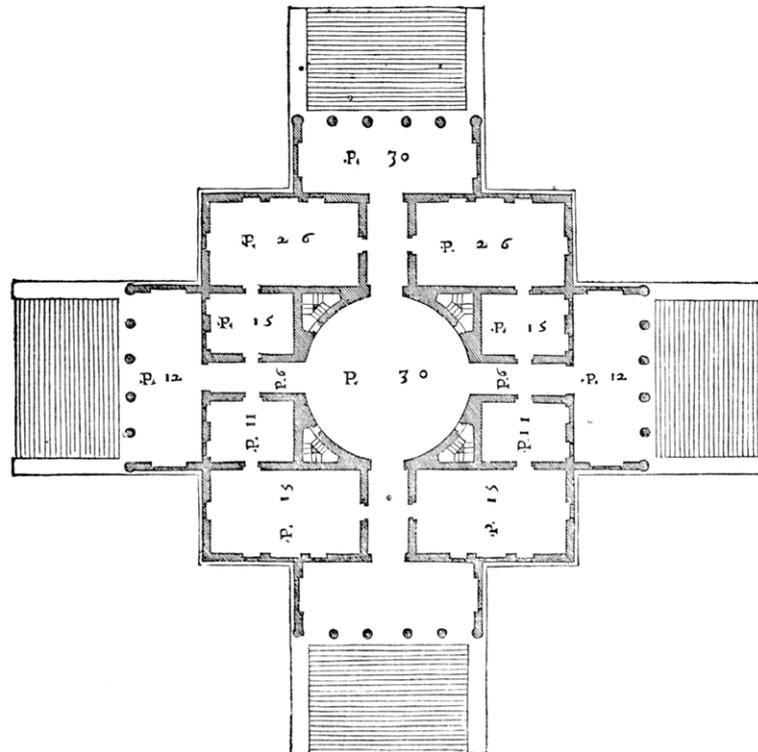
Planta de la Villa Rotonda (Andrea Palladio, 1566).
